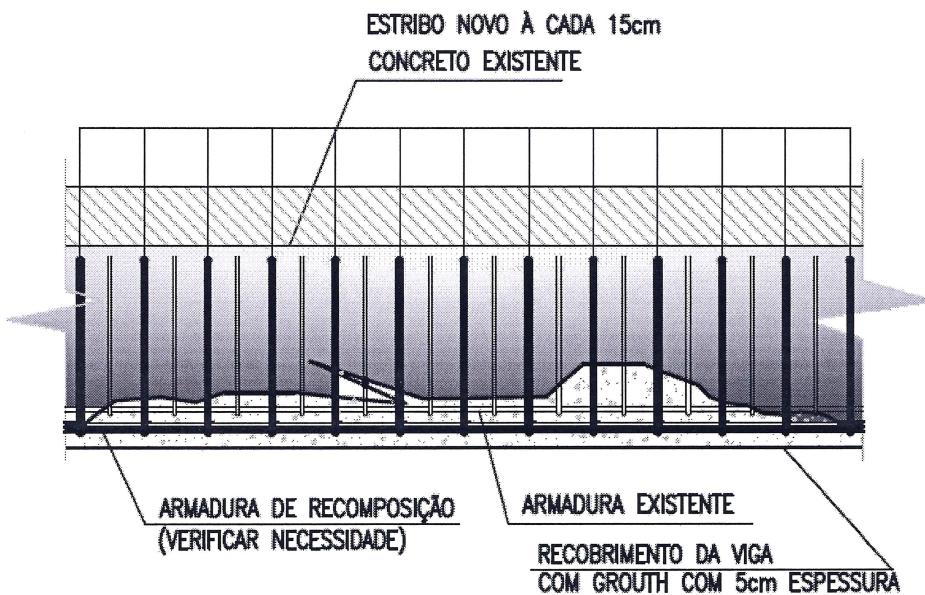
Recomposição de laje ou viga (Instalação de armadura de reforço e recobrimento com grouch)
